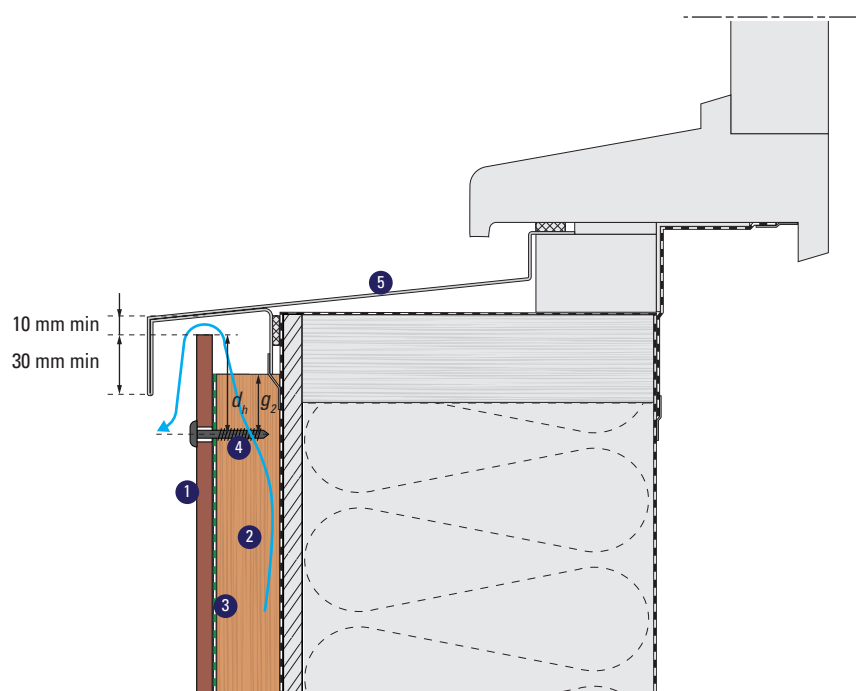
Exemple de mise en œuvre en linteau de baie – coupe verticale
